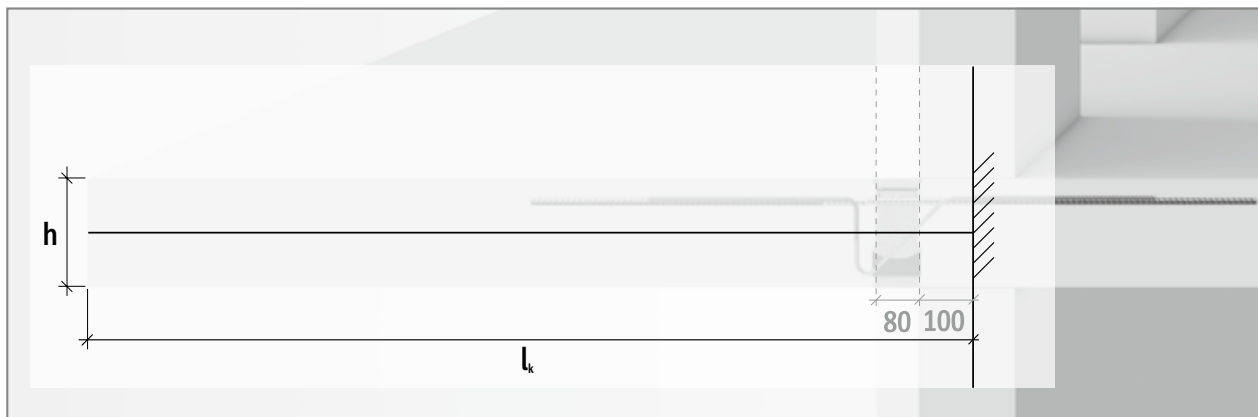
Schöck Isokorb® T tipo KL: rapporto luce-altezza
